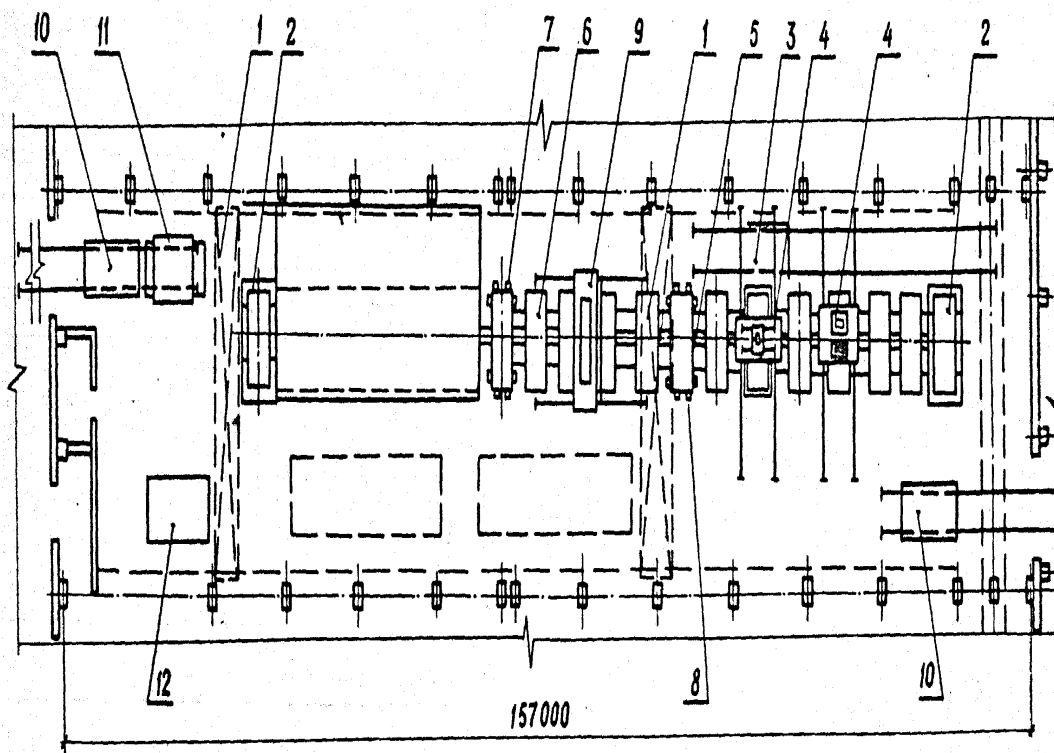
Схема технологической линии по производству железобетонных ребристых плит перекрытий:
